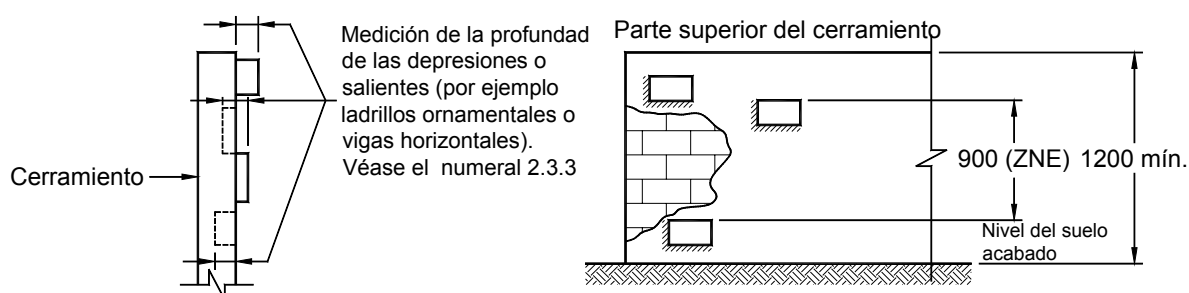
(Final) Dimensiones perpendiculares del cerramiento
